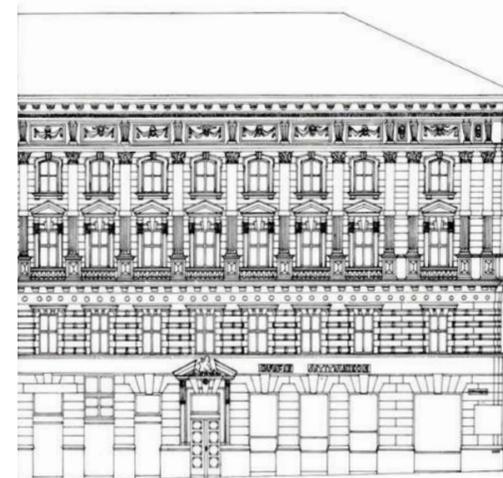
Schwindgasse 19 – Grundrisse Einreichplan 1876, Fassade 1980
